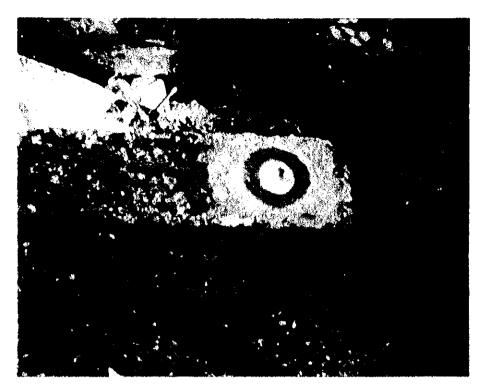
BM • 1 UBICADO ESQUINA SUR - ESTE RECEPCION DE VEHICULO CASA PELLAS
